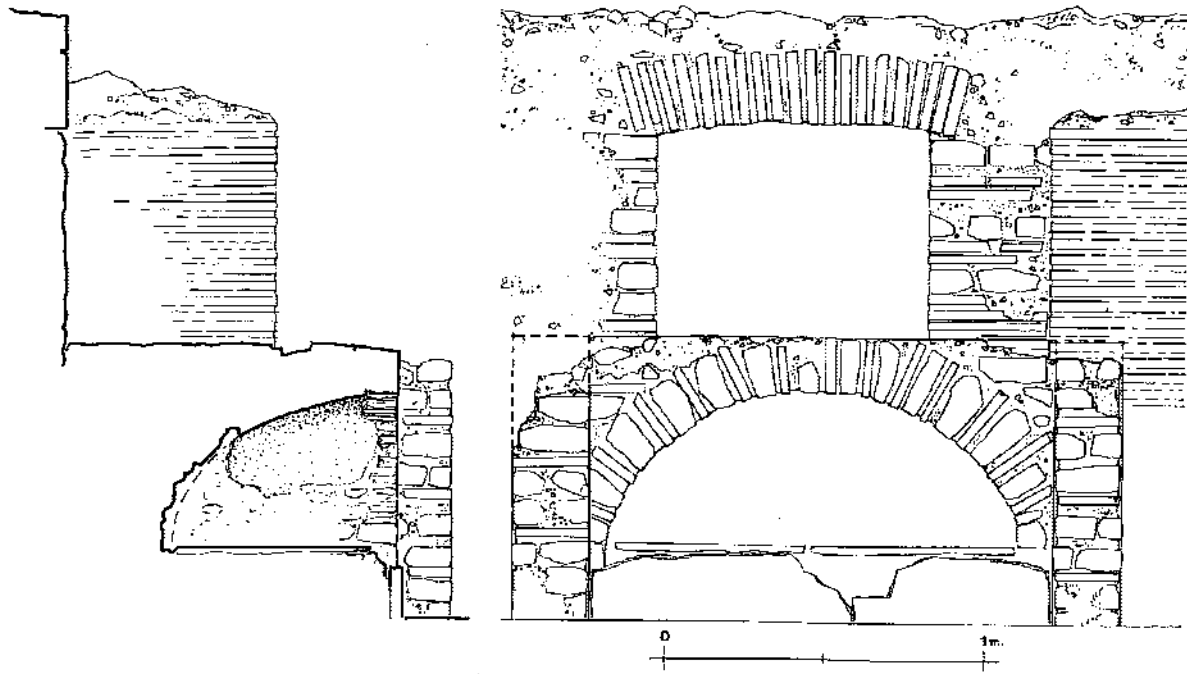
Alzado de los elementos de la fuente (A en figura 48) construida en el patio de Baco y Ariadna.
